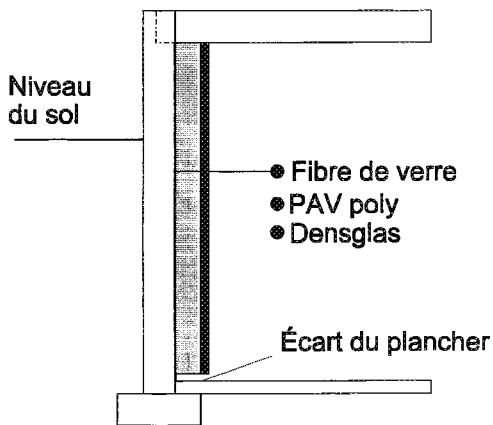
Panneau d'essai 7 – Construction ordinaire améliorée avec poly, Densglas et écart du plancher.
